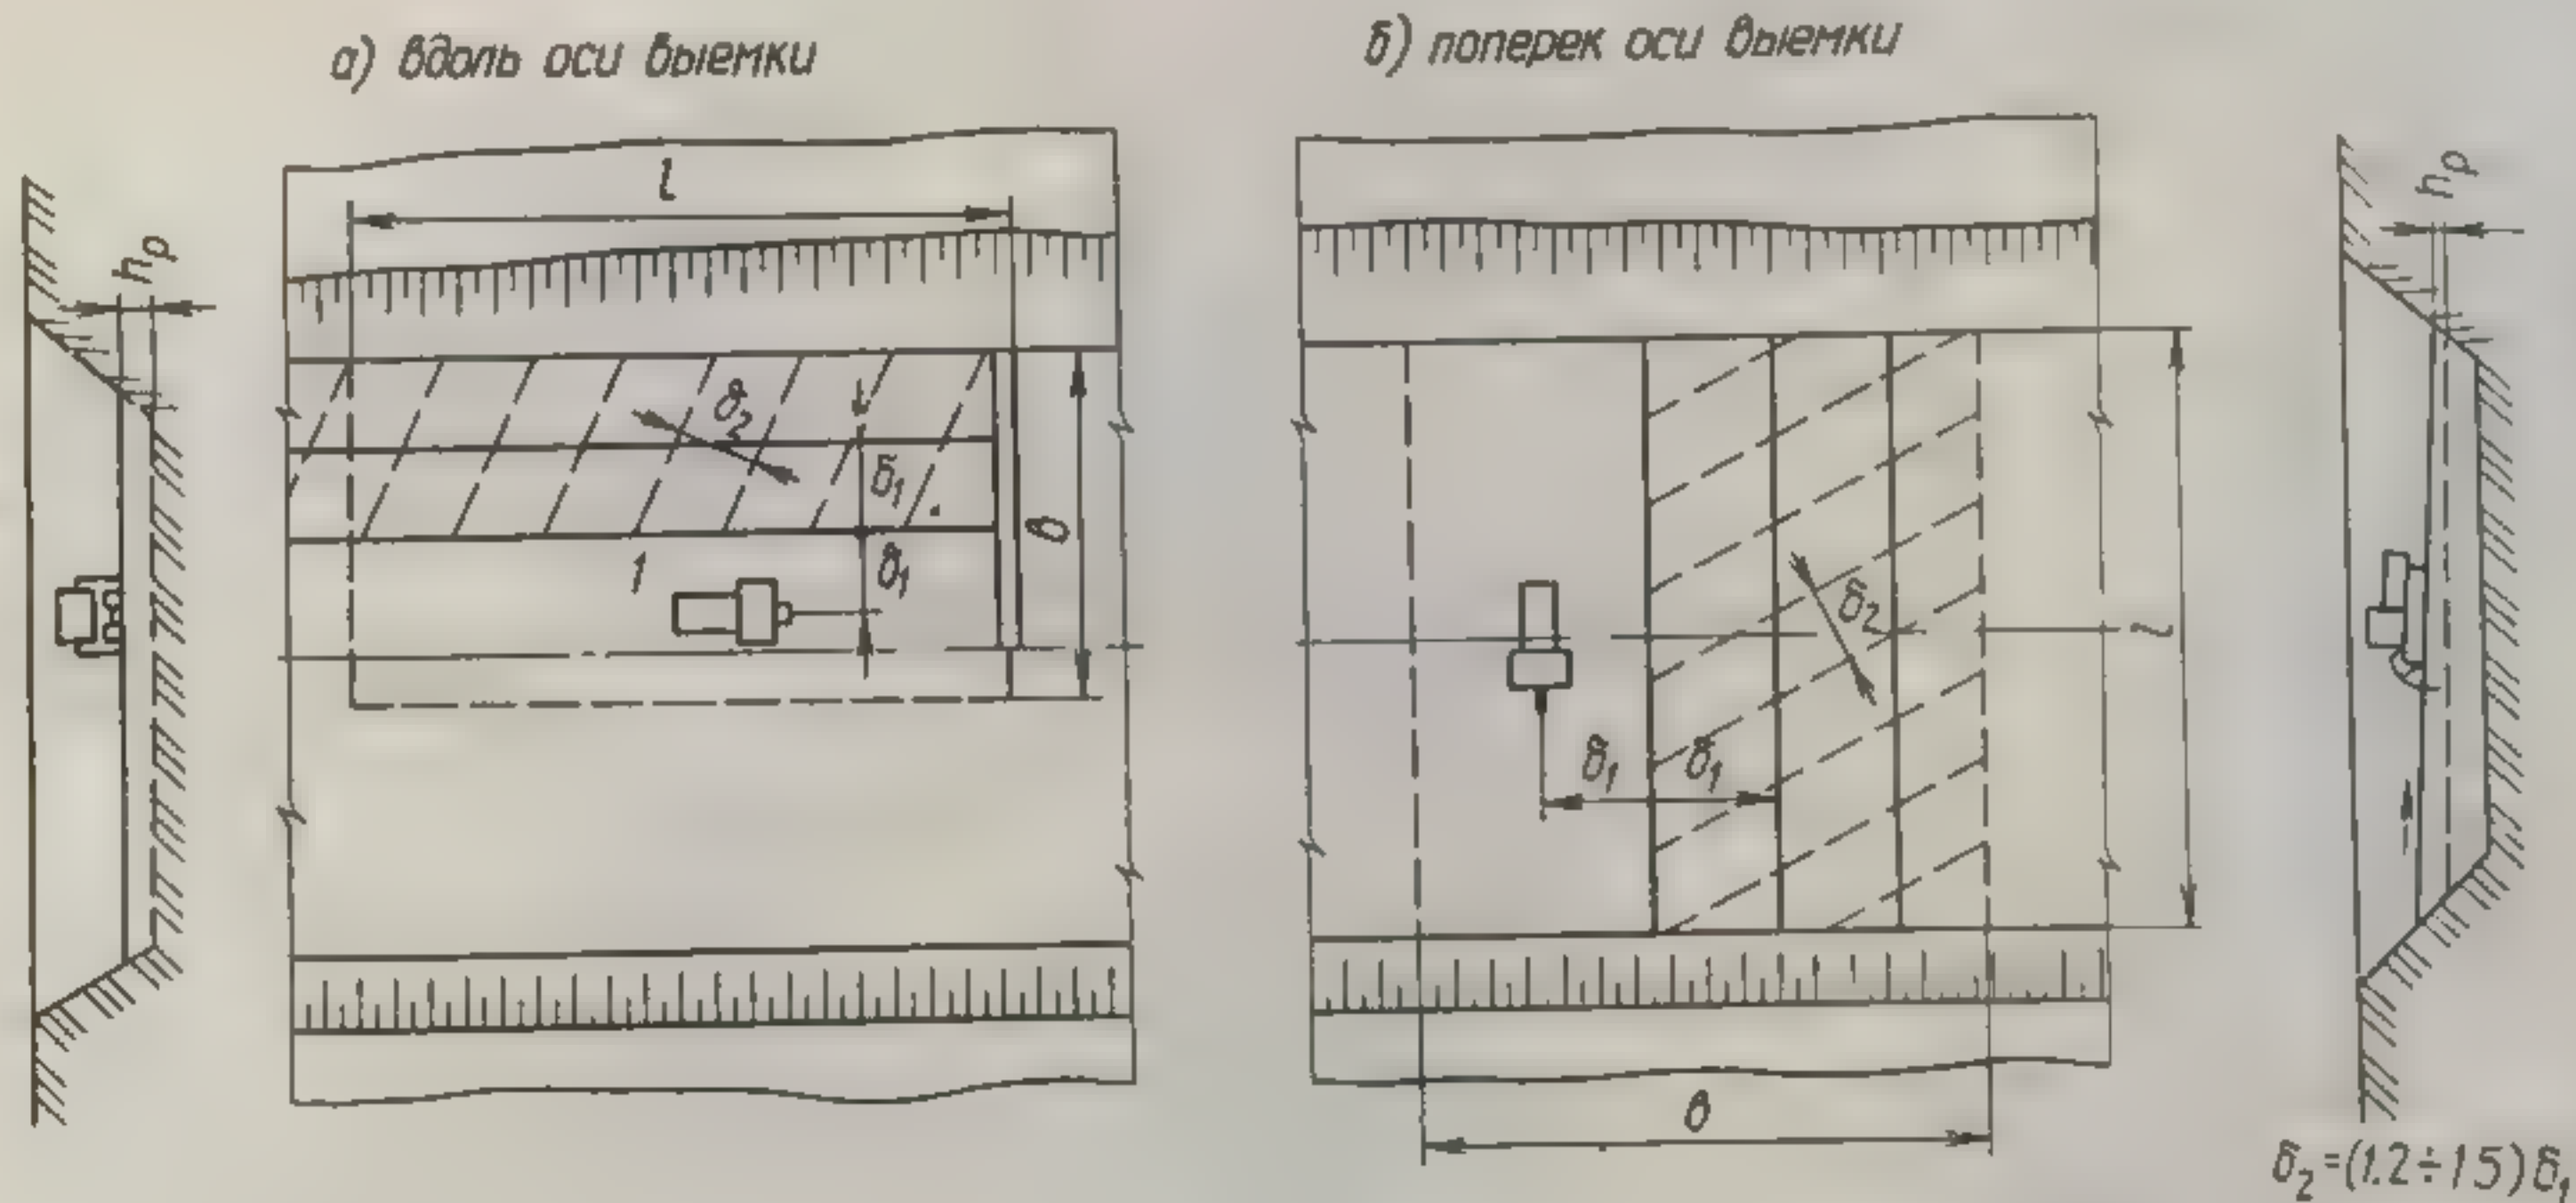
Схема механического рыхления грунта в выемке:
